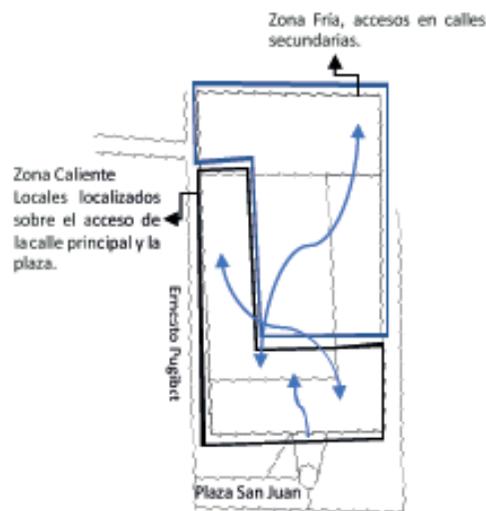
, 2 y 3: Mercado San Juan. Fotografías y planimetría de la autora.
